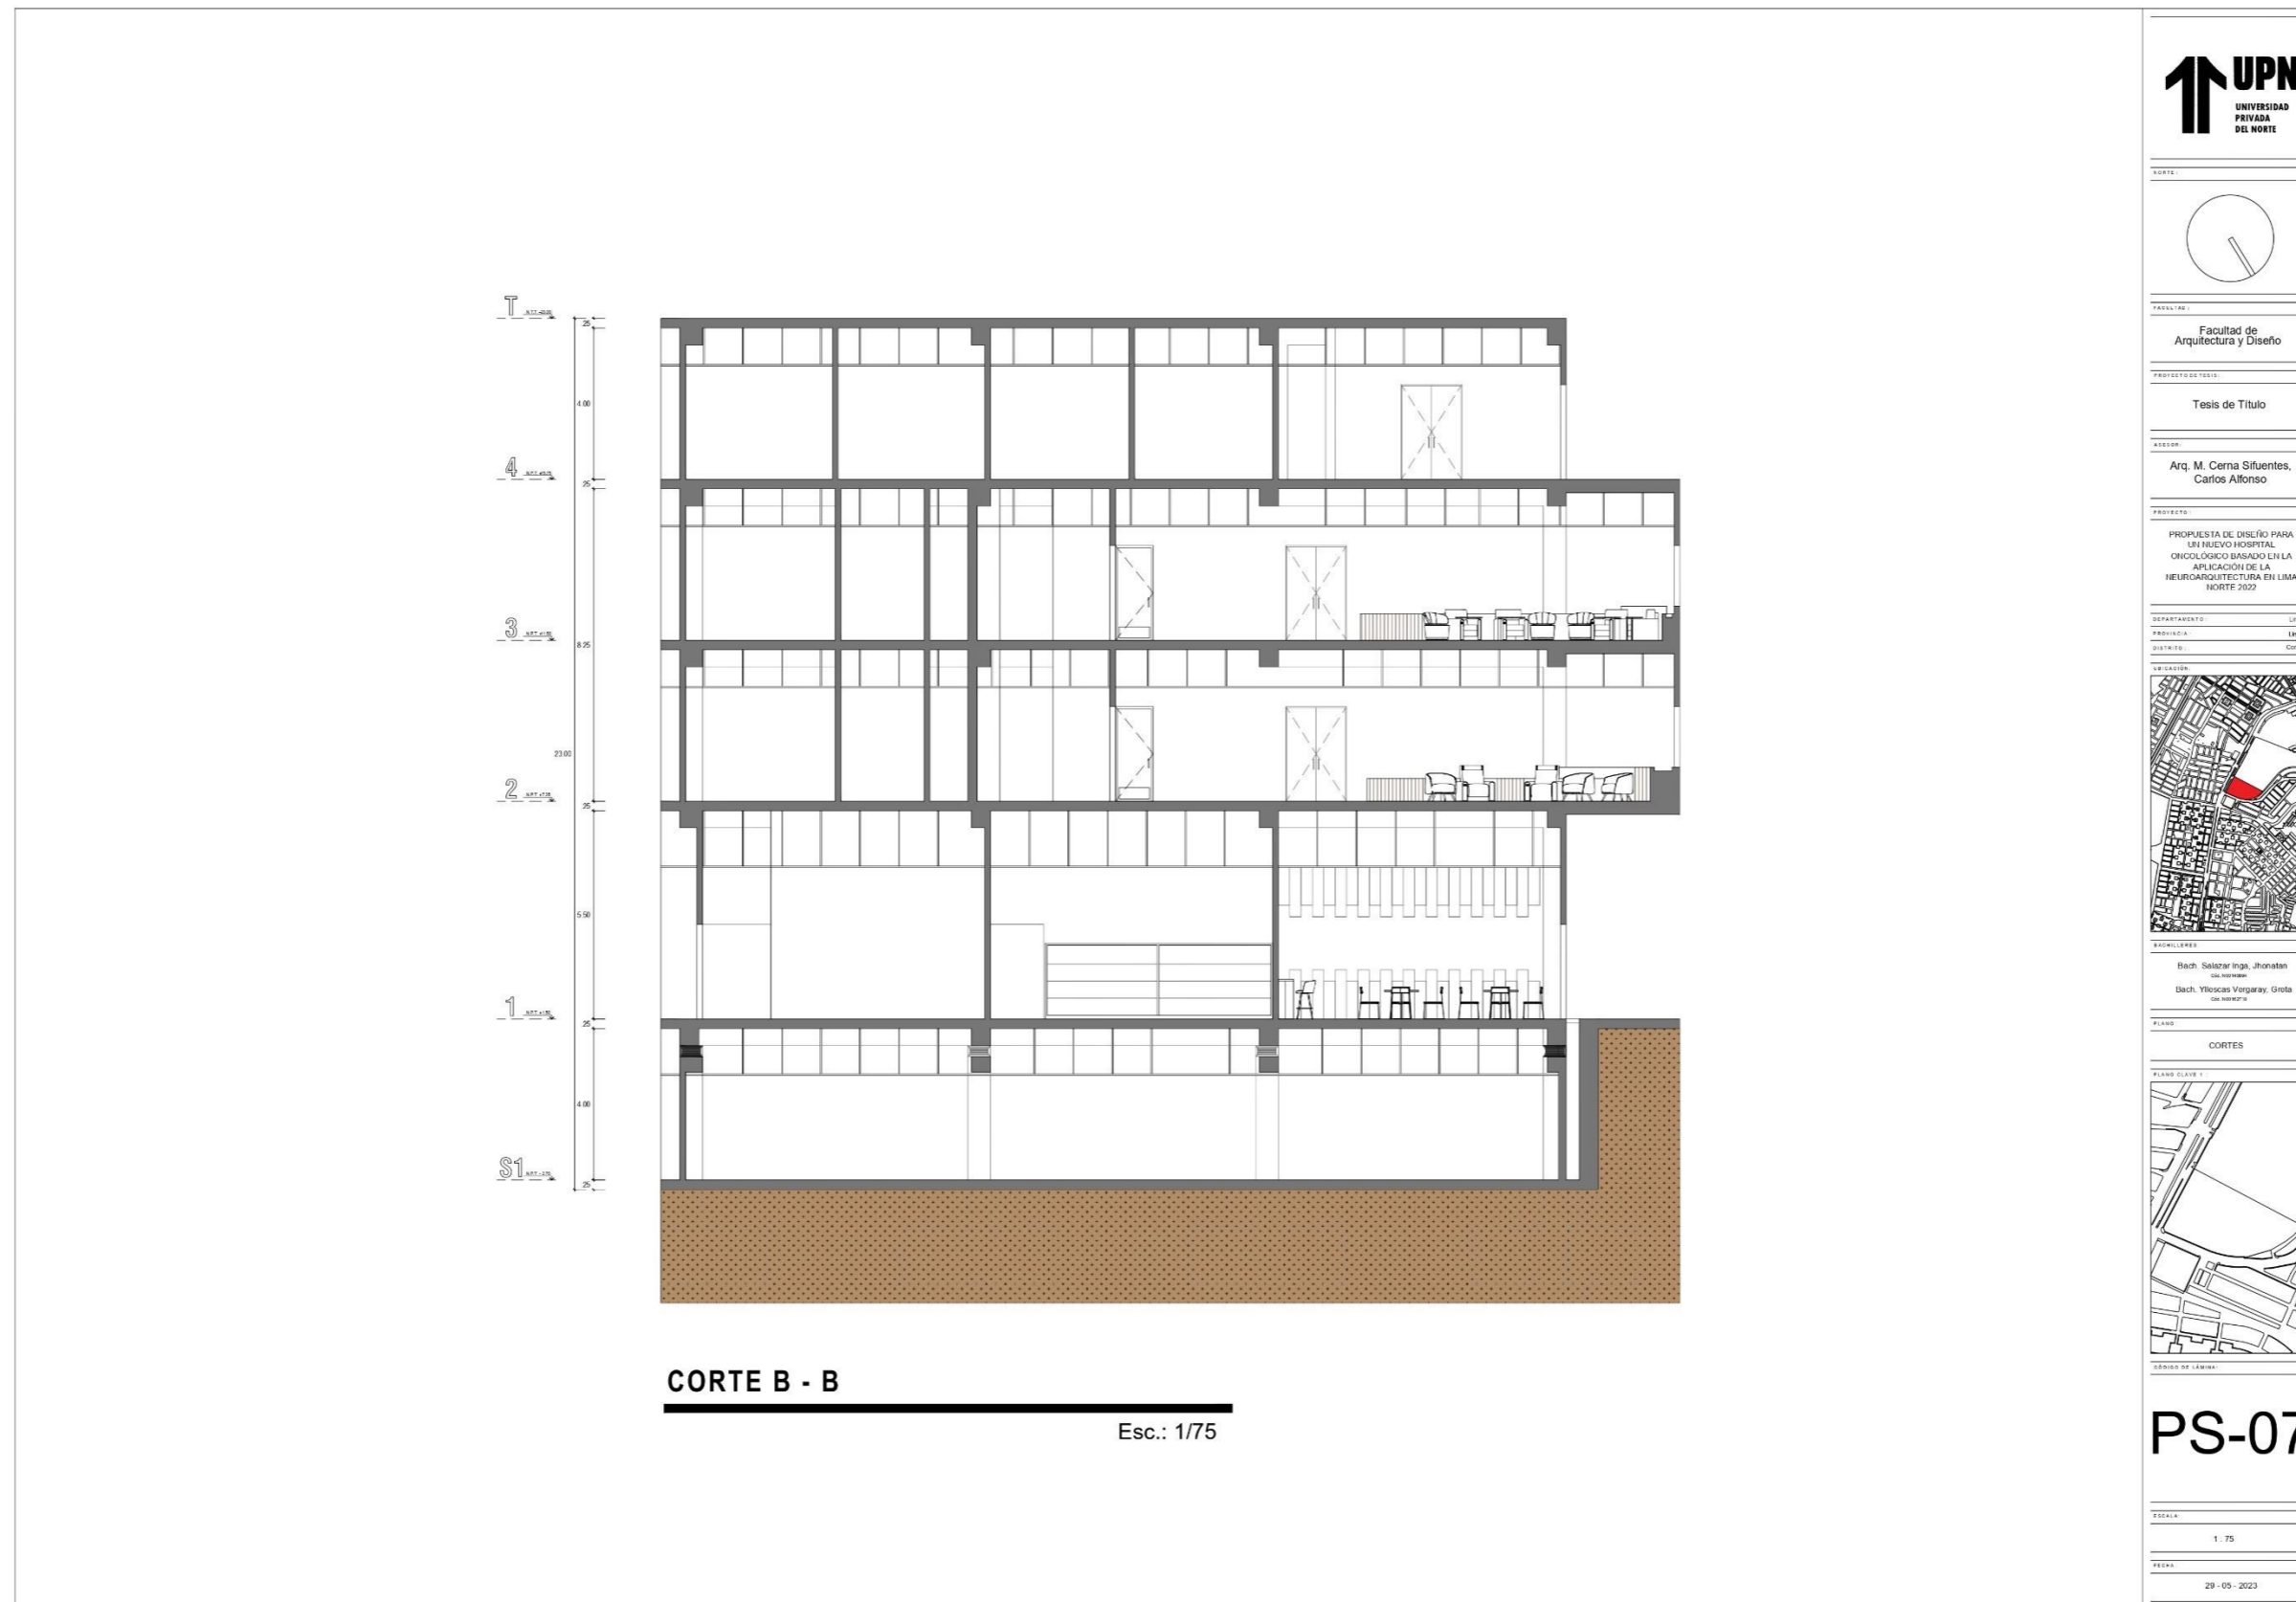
Arquitectura – Cortes N°2 del sector cuadrante Esc: 1/75 (Fuente: Elaboración propia de los coautores)
